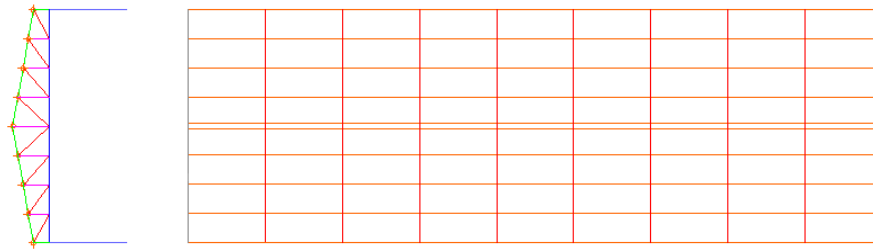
Representação das terças na planta de contraventamentos da estrutura.
